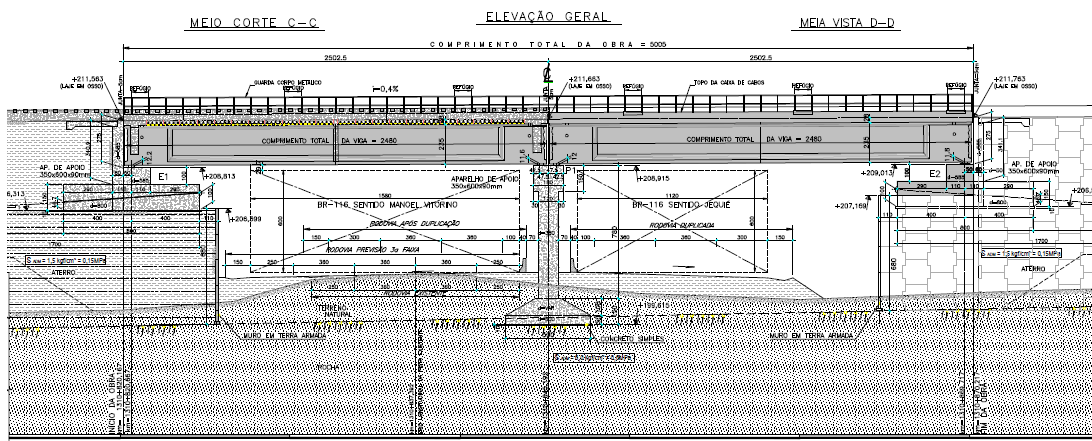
Esquema da elevação geral - Viaduto BR 116
